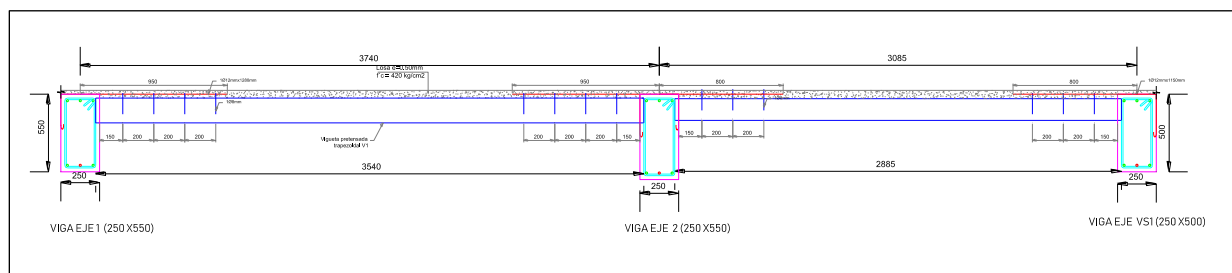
Vista longitudinal de la vigueta pretensada con las vigas reforzadas.
